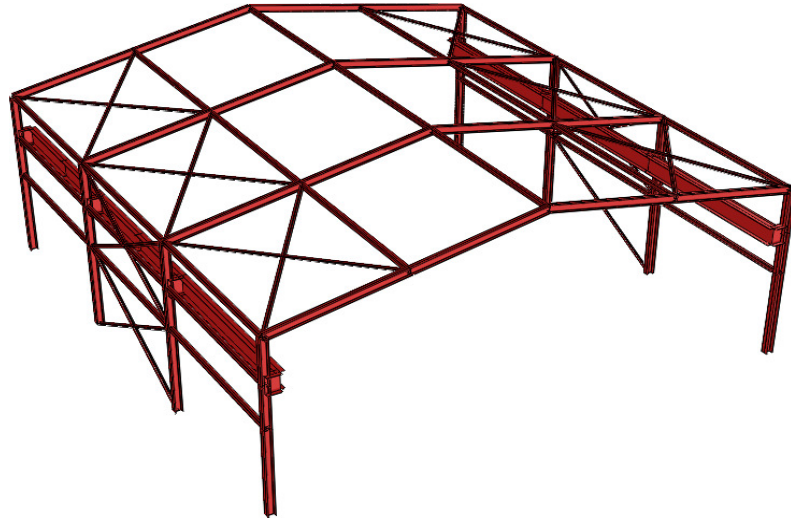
Estrutura lançada no STRAP 2014 para dimensionamento do galpão em aço
